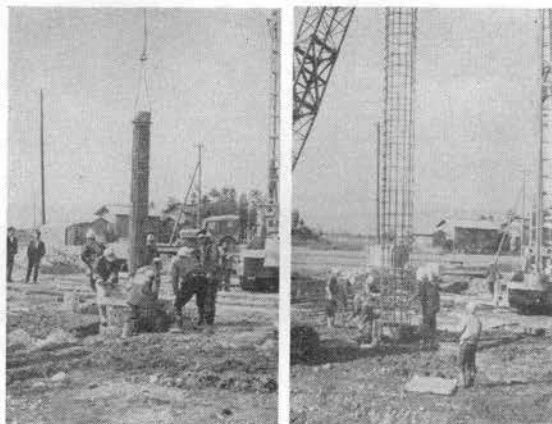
鉄筋の建込み 写真-3 トレミー管そう入
